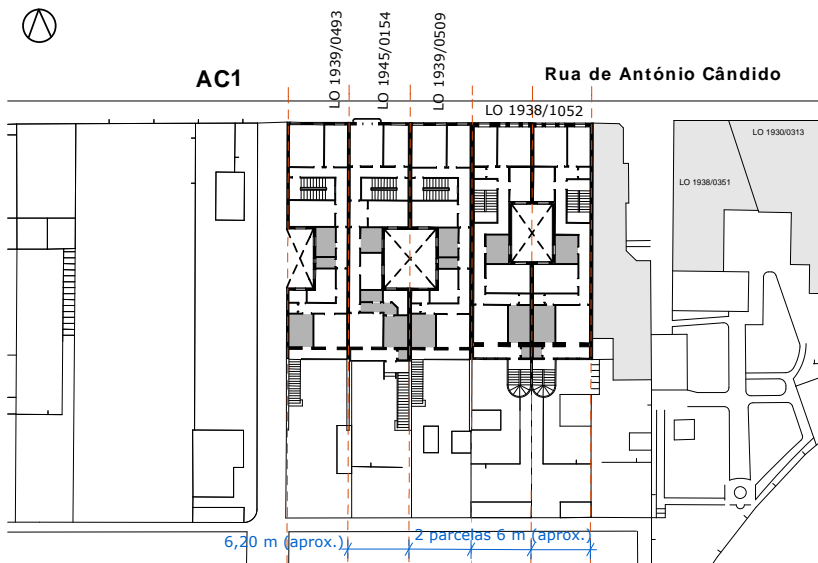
Sectores na Rua de António Cândido. Plantas do piso-tipo. Esc. 1/750(aprox.). (desenho da autora)
